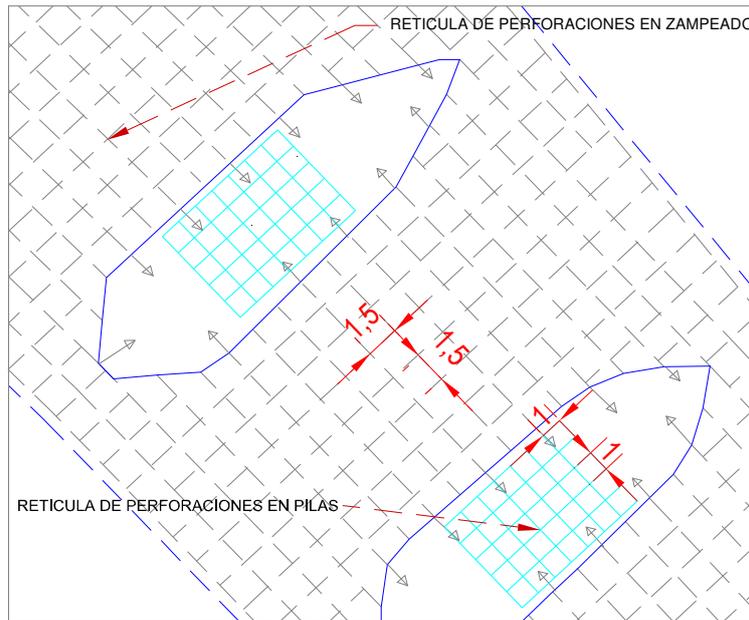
Detalle de replanteo de perforaciones desde las pilas y desde el lecho del río.
